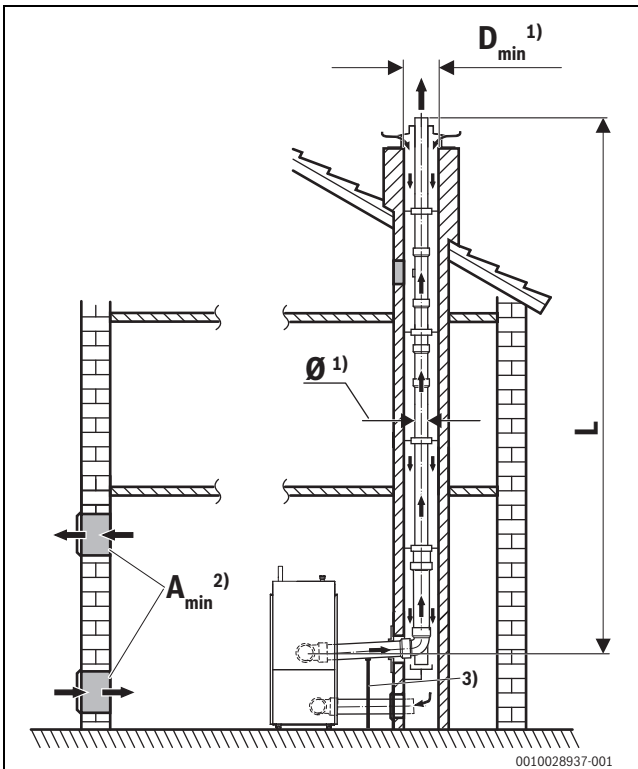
Hauteur effective de la conduite d'évacuation des fumées, dans le conduit, variante 1
